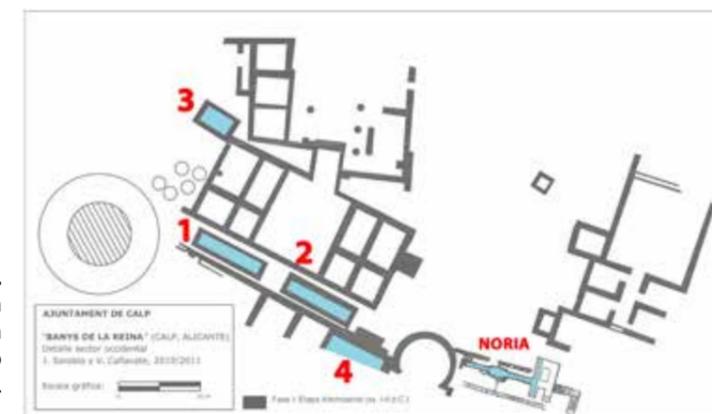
Sistema hidráulico de la Vivienda 2. Plano de J. Sarabia y V. Cañavate, 2011
